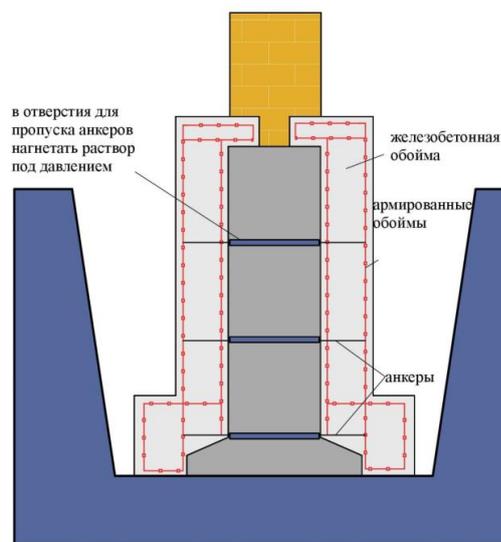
Железобетонная обойма на ленточном фундаменте
